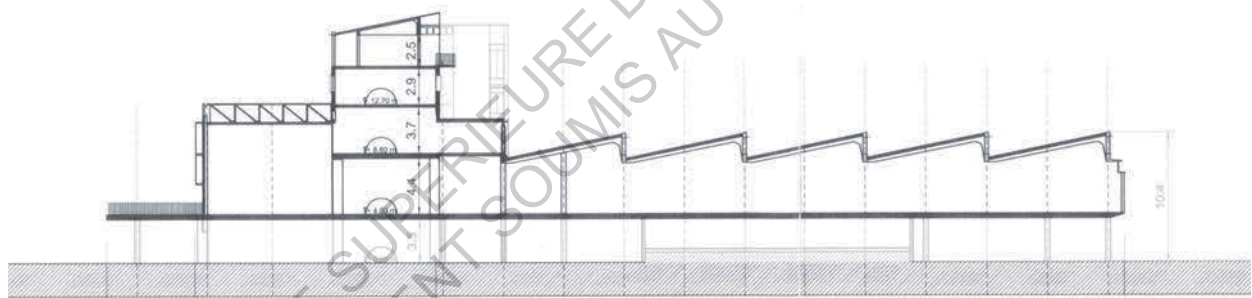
Coupe longitudinale du restaurant universitaire (redessiné par l'agence Atelier 13)
